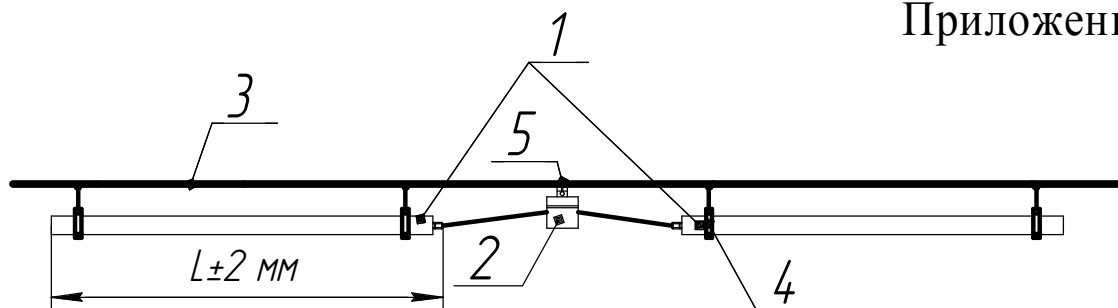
1 - Корпус; 2 - распредел. коробка; 3 - трос для подвеса светильников;
